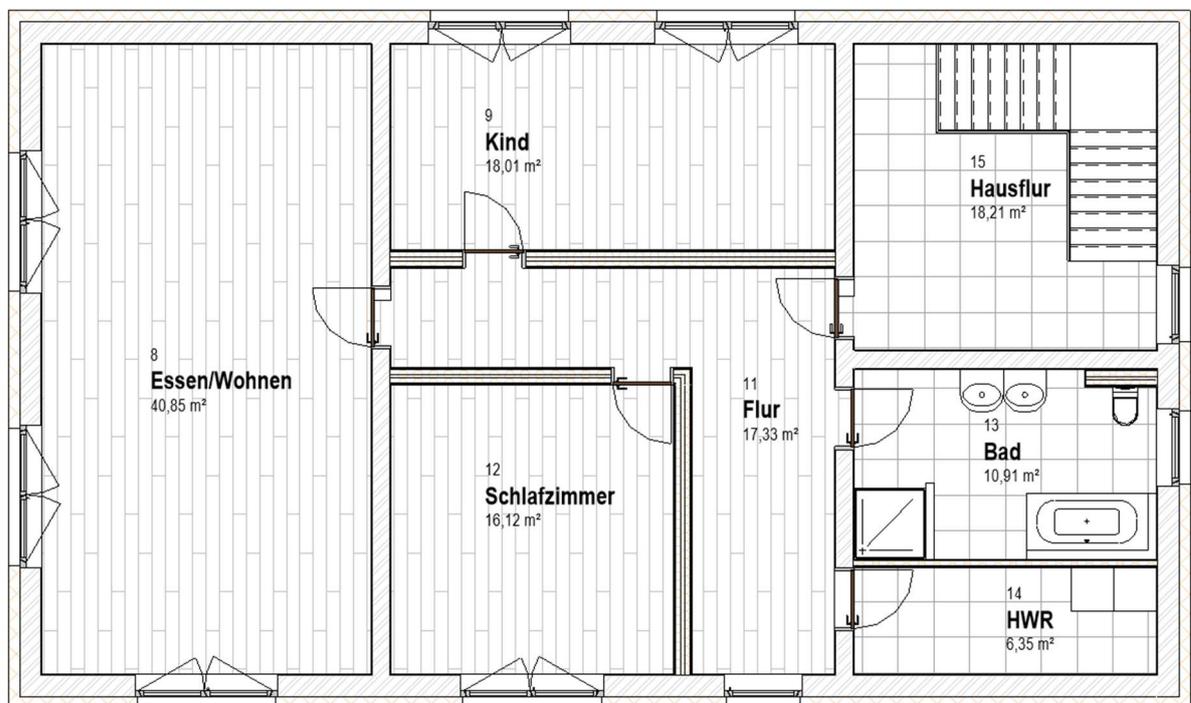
Grundriss des geplanten Obergeschosses
